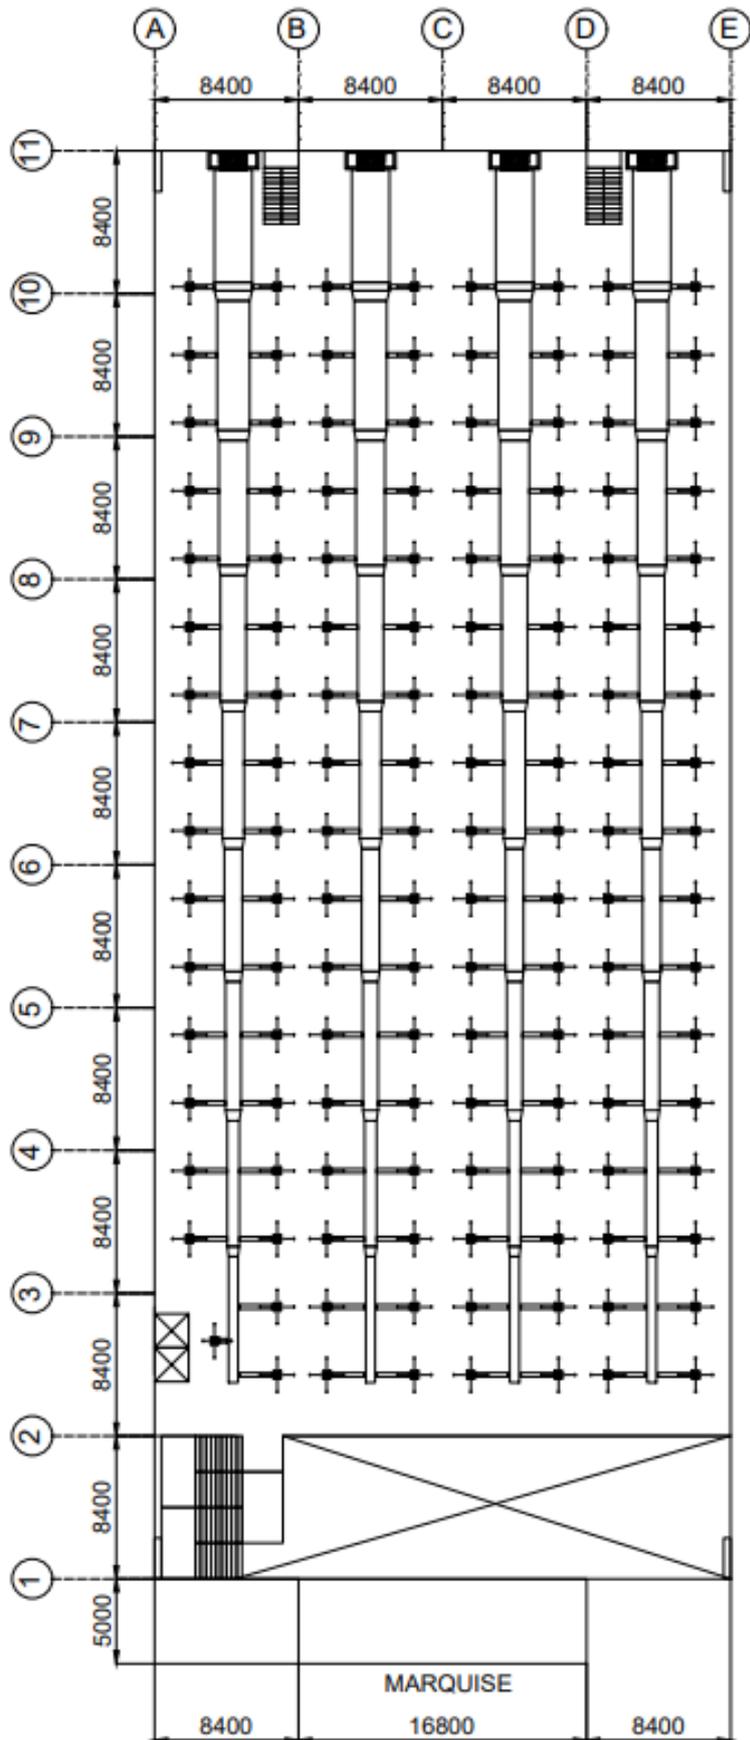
Planta do primeiro piso, mostrando a tubulação do ar-condicionado (medidas em mm).
